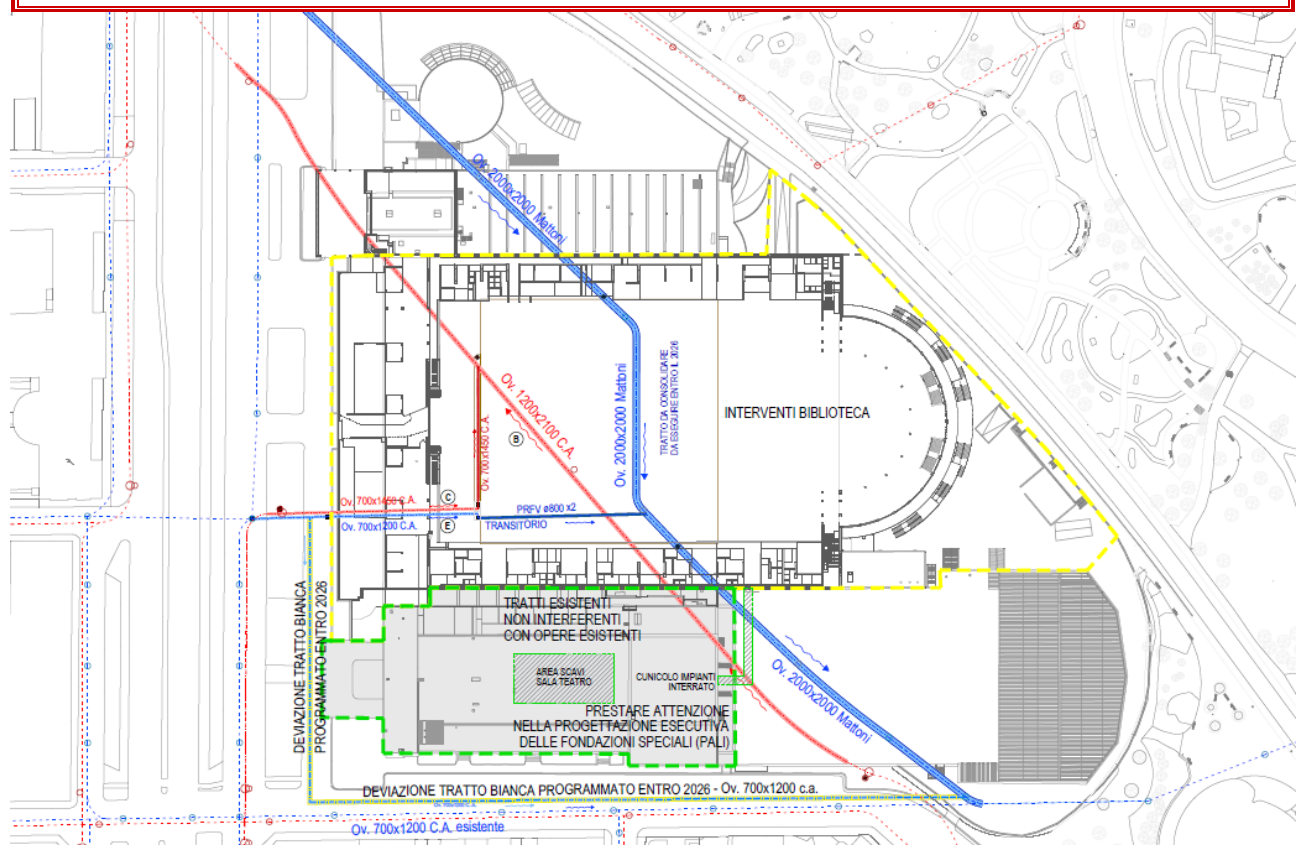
Planimetria rete fognaria principale, modifiche Biblioteca e integrazione perimetro di intervento TNT
